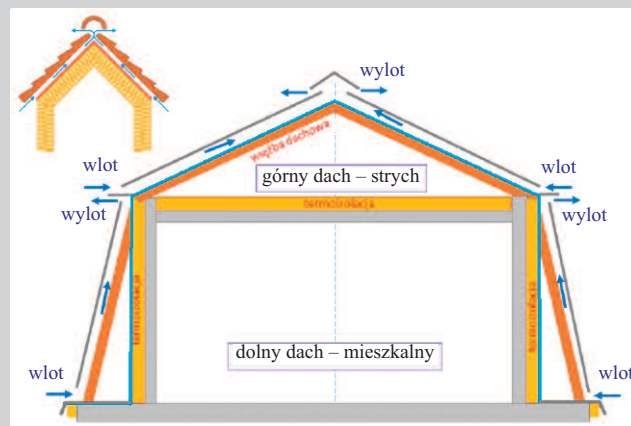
Dach z mansardą właściwą z pokryciem opartym na jednej więźbie dachowej
